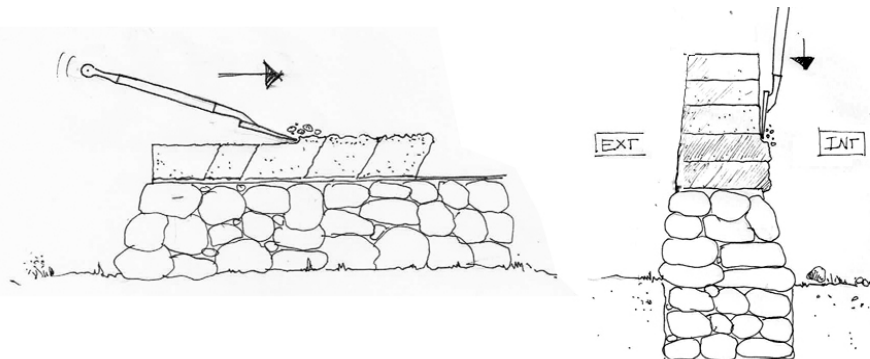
Emparejado de planos horizontales y verticales. Ilustración del proyecto *enTerrón*, 2013.
